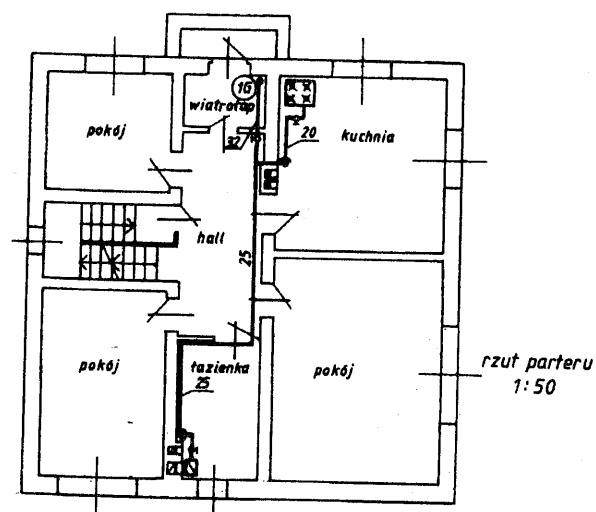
Przykładowy rzut parteru wchodzący w skład projektu mechanicznej instalacji wentylacyjnej
